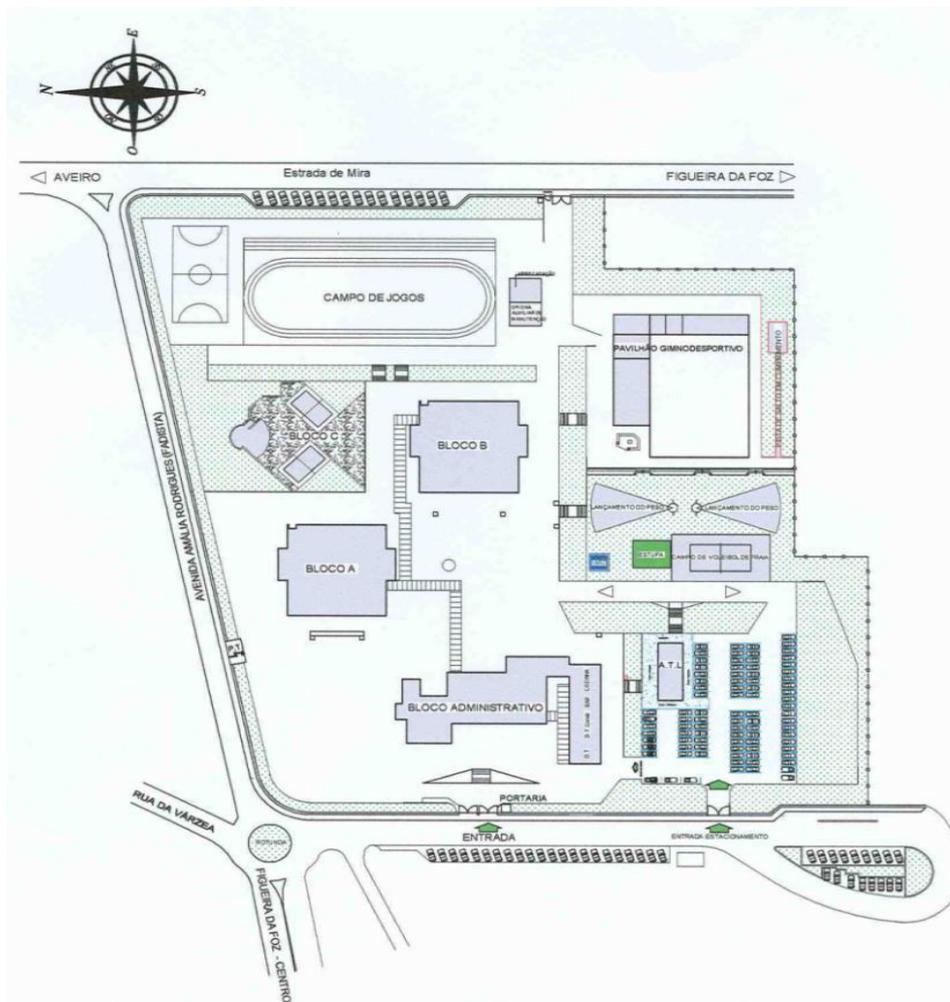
PLANTA DE CONJUNTO / LOCALIZAÇÃO
